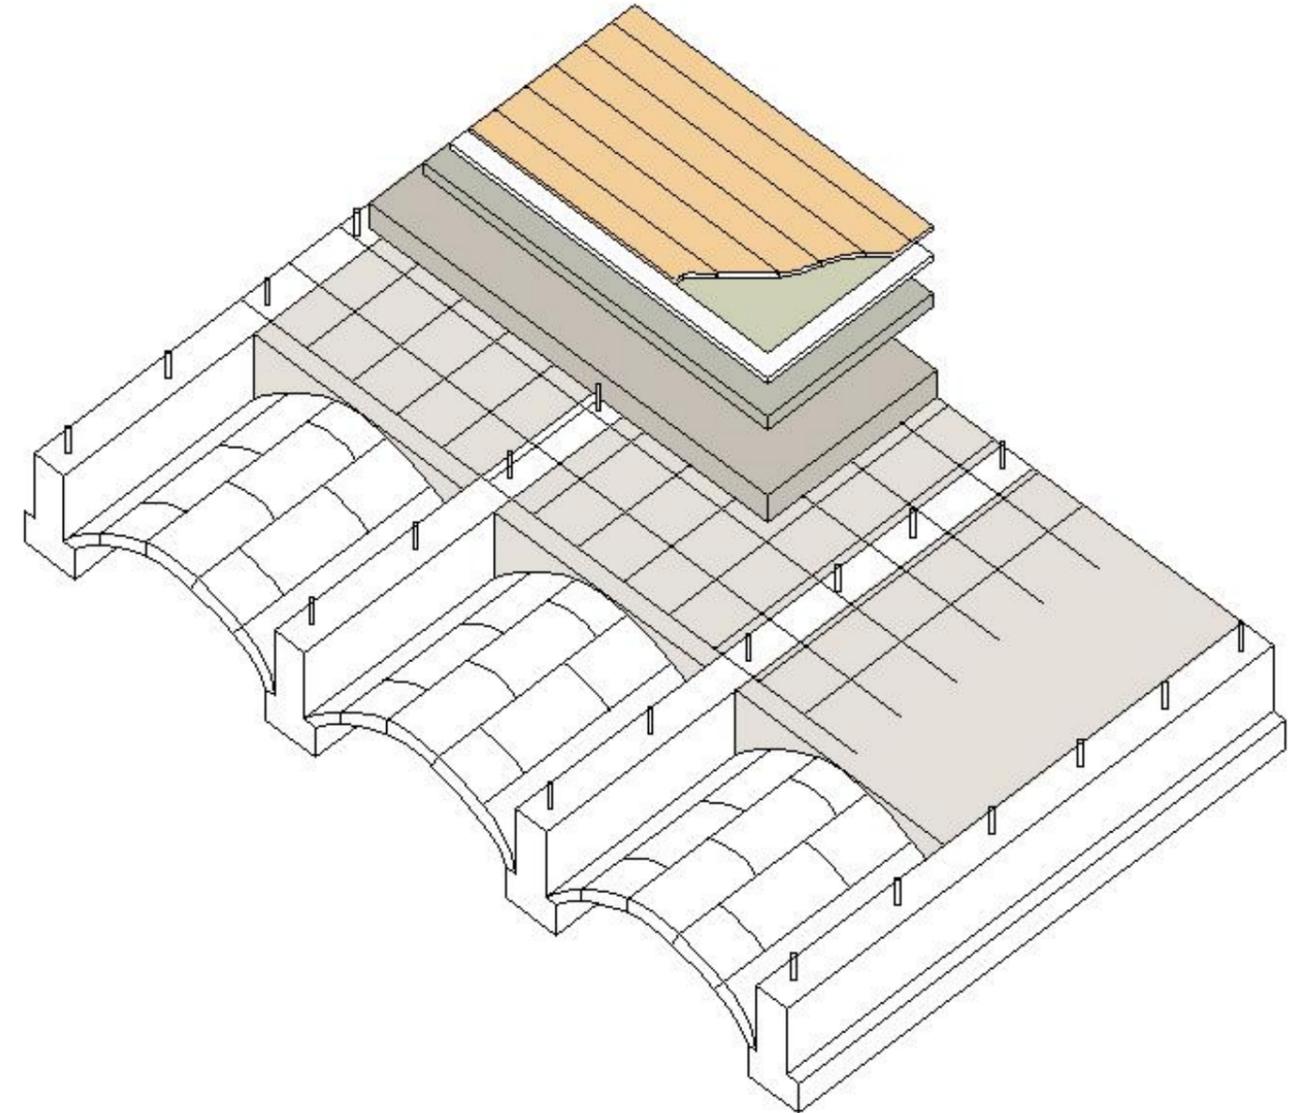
Esquema de forjado estado propuesto. Año 2014. Fuente: propia autora
